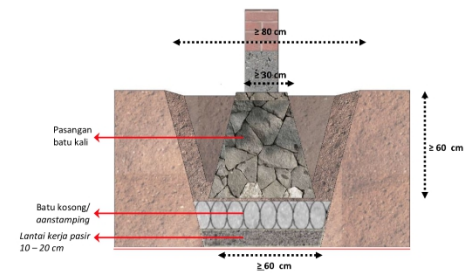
Struktur Bangunan Rumah Tinggal Tunggal
